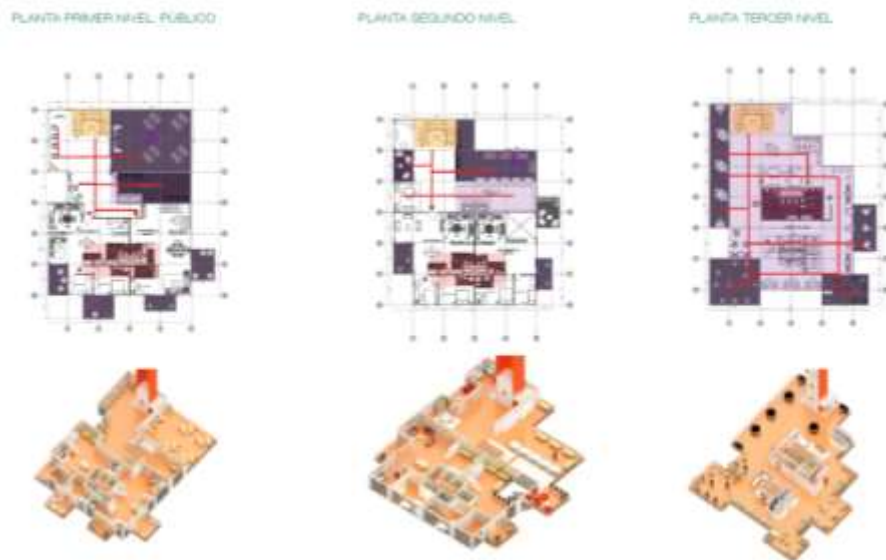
Propuesta de plantas tipo 1, 2 y 3. Autoría propia (2020)
